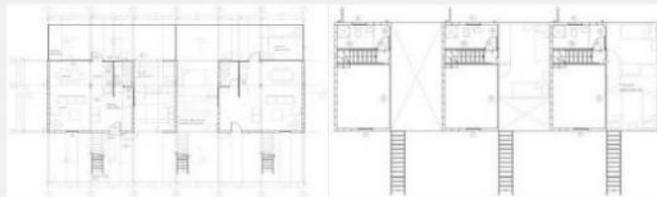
Planta Quinta Monroy (Elemental, 2003)
